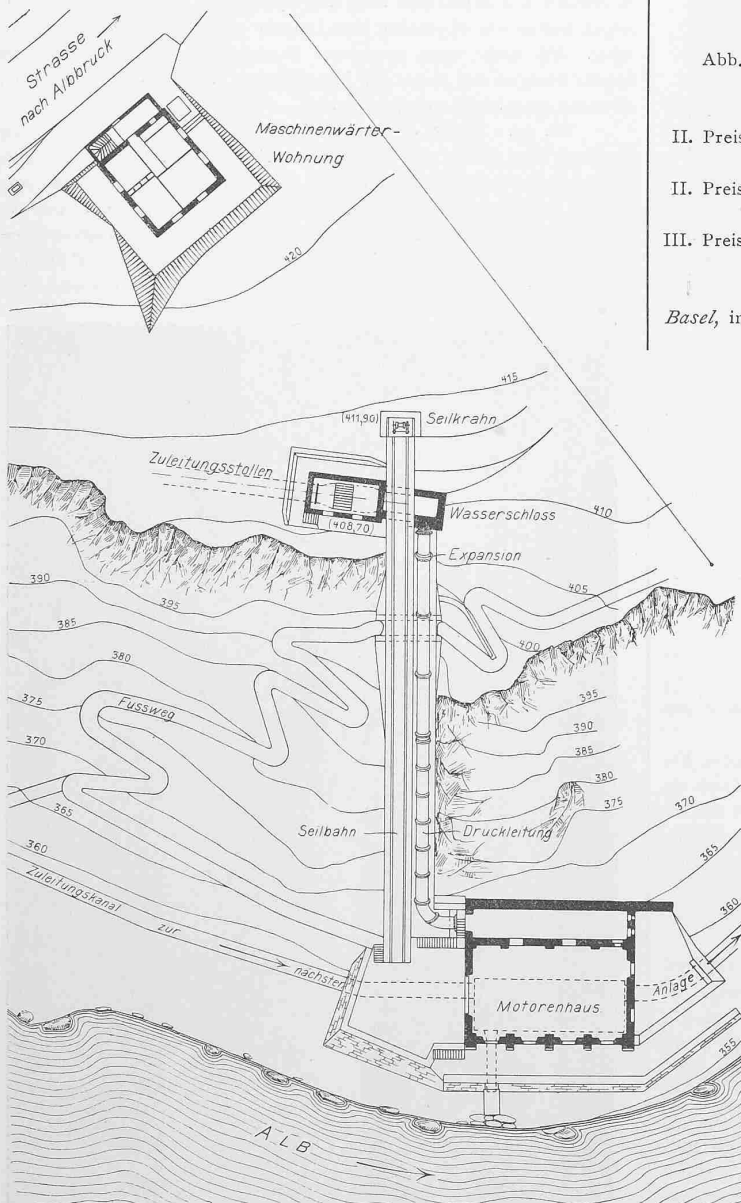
Lageplan der Kraftanlage mit Motorenhaus, Druckleitung, Seilbahn, Wasserschloss und Maschinenwärterwohnung. — Masstab 1:700.
